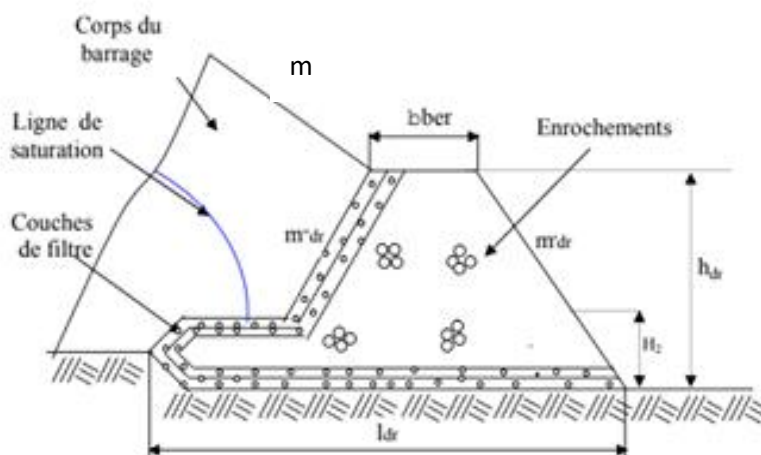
Prisme de drainage avec drain tapis interne sur fondations perméables.
